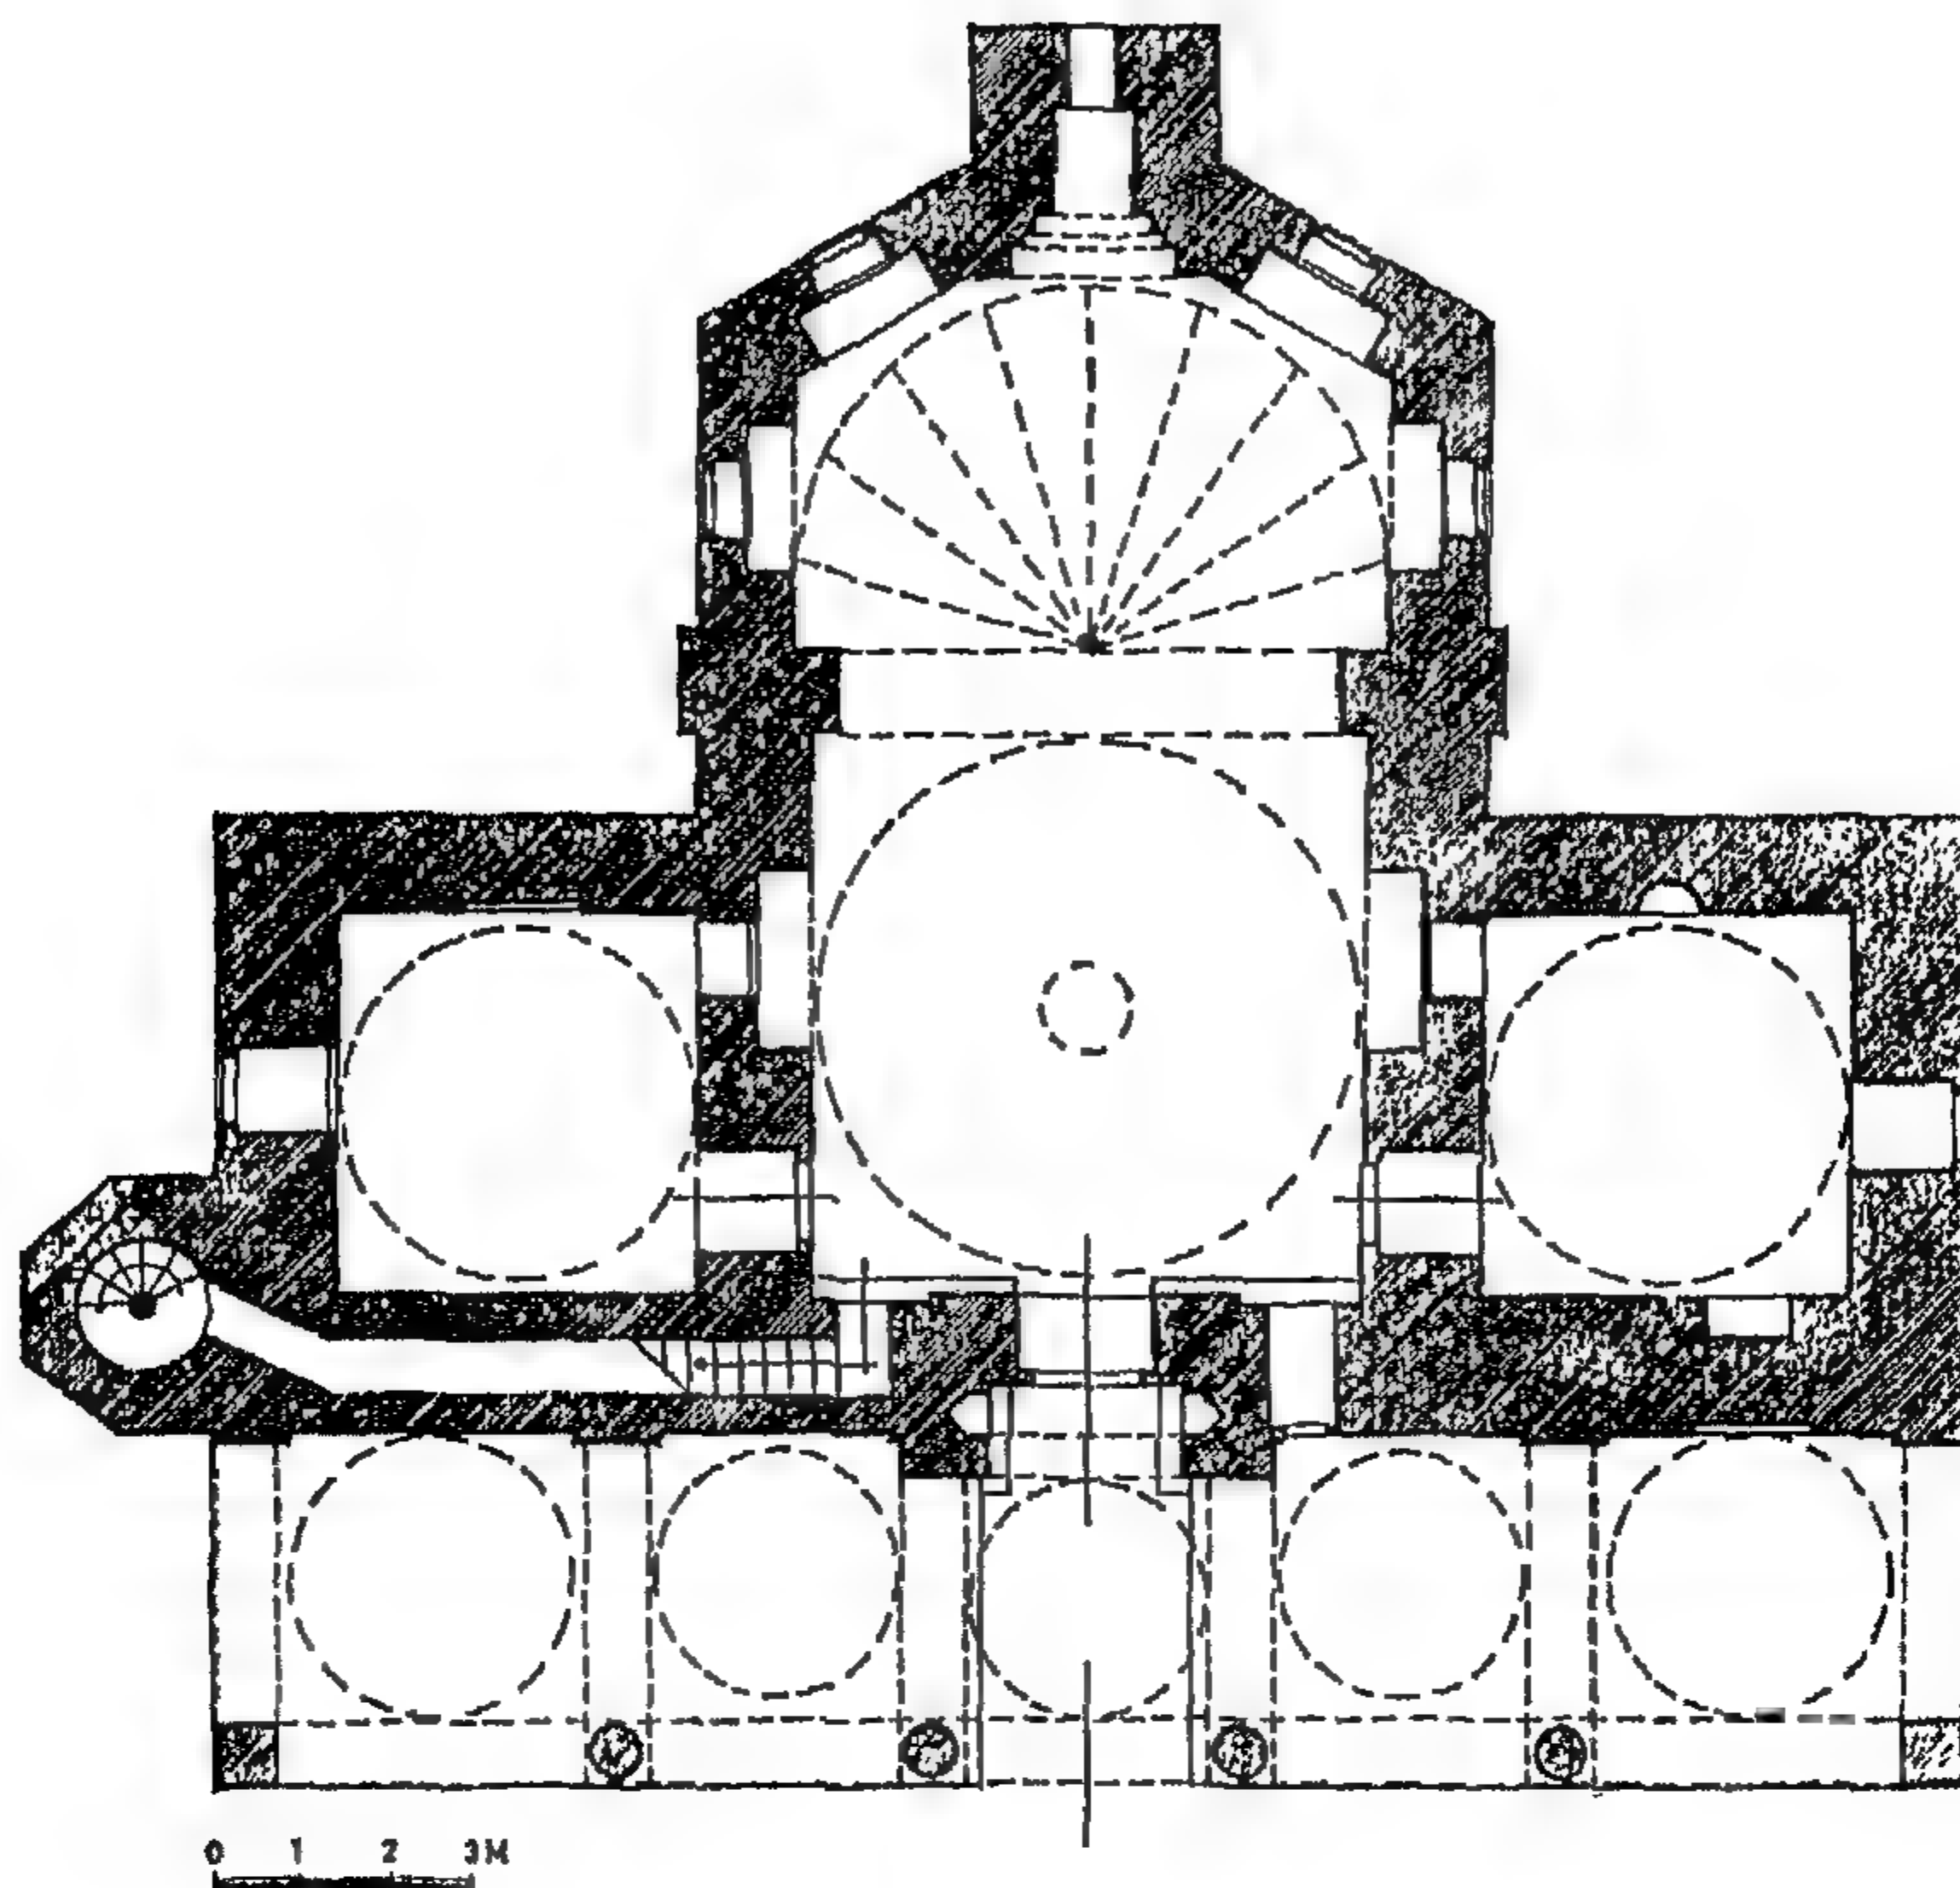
مسقط أفقي لعمارت وتربة يعقوب جلبي بازنيق
